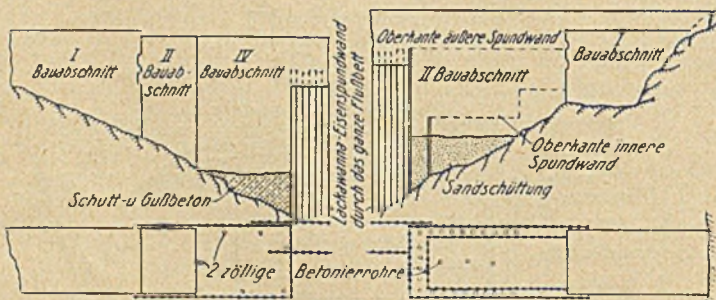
Anschluß der Sperrmauer an die Uferfelsen und Grundriß der eisernen Fangedämme.
